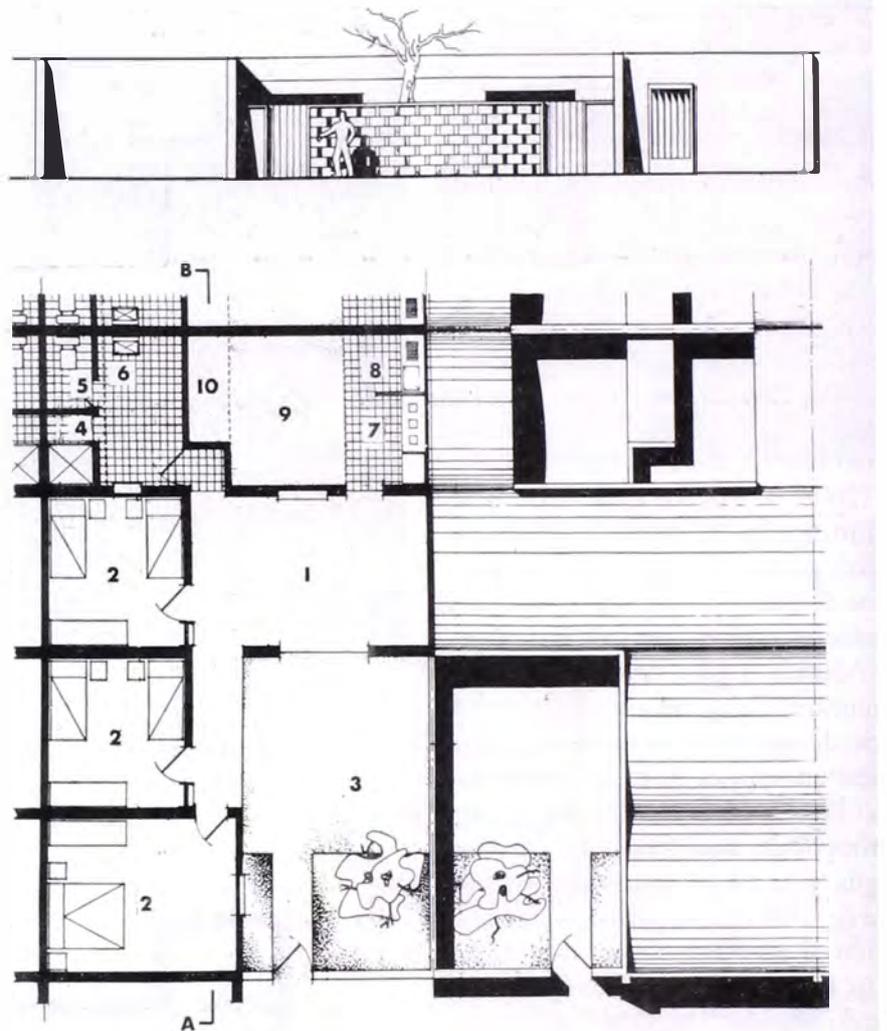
Fachada y planta baja propuesta para vivienda en Chimbote.
